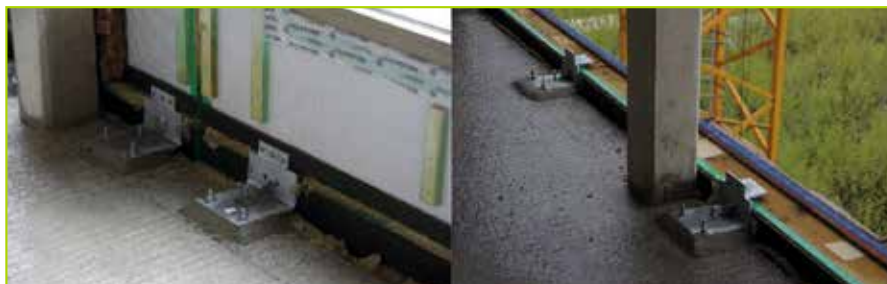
Élément de façade E 60 à ossature en bois, fixation R 60 sur la dalle et resserrage EI 60 avec le nez de dalle. A gauche : modules inférieur et supérieur placés ; à droite : module inférieur placé (photos CSTC – chantier URBICOON, Anvers – MBS).
